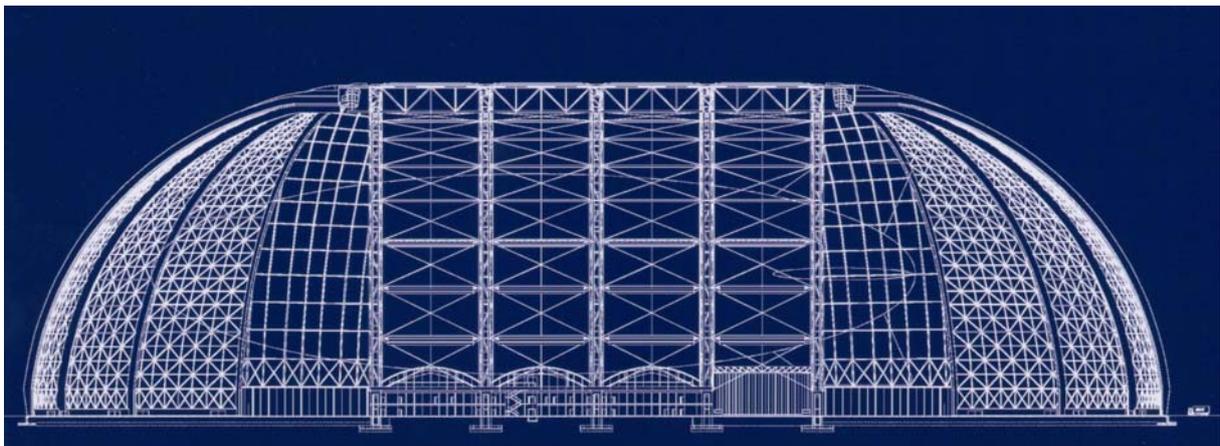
Skizze der Tragkonstruktion der Cargolifter-Halle in Brand (Brandenburg)
